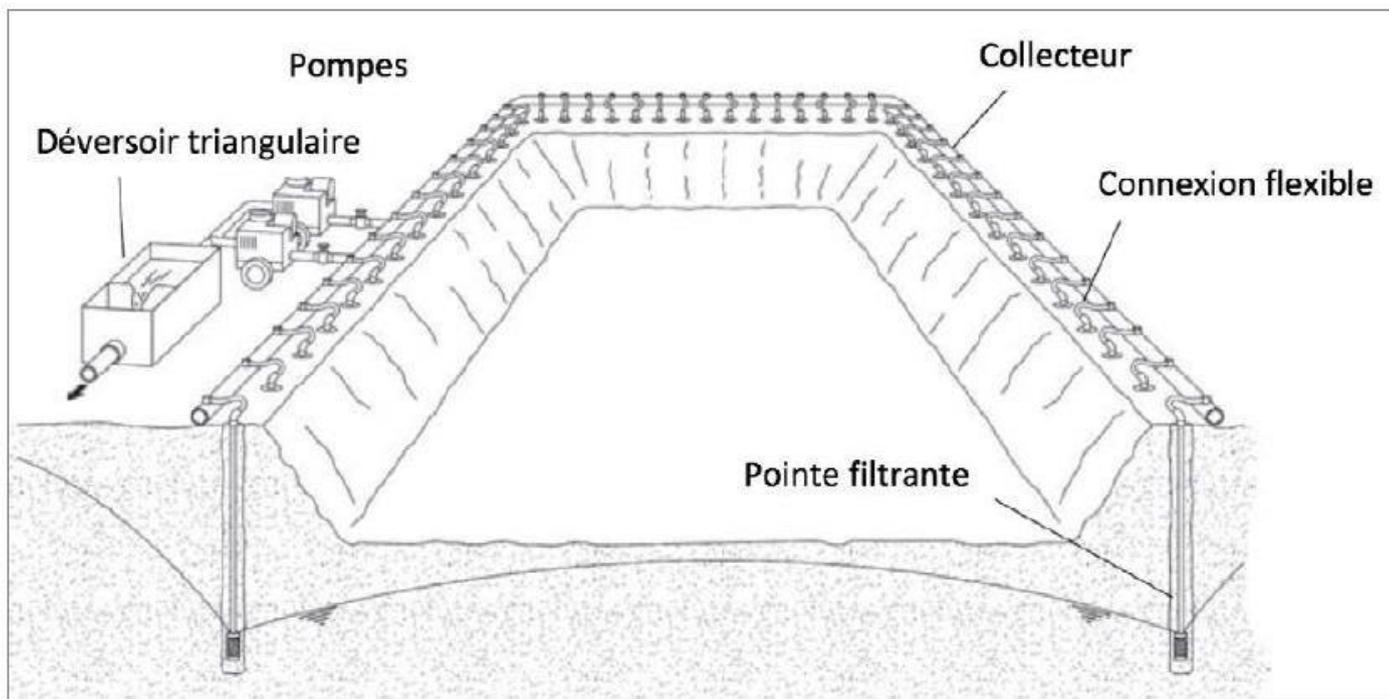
Dispositif des pointes filtrantes autour d'une excavation (Source : CFMS)
